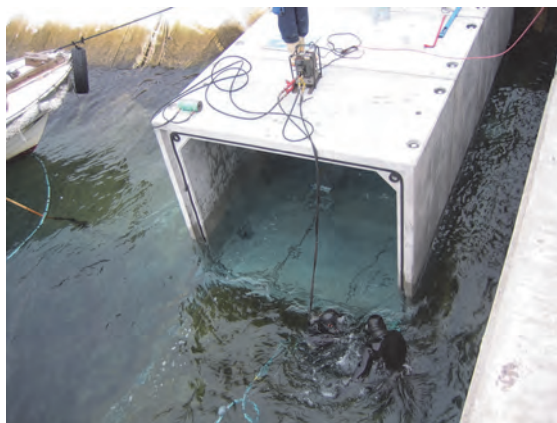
緻密コンクリートによるプレキャストボックスカルバートの海中施工事例その1
